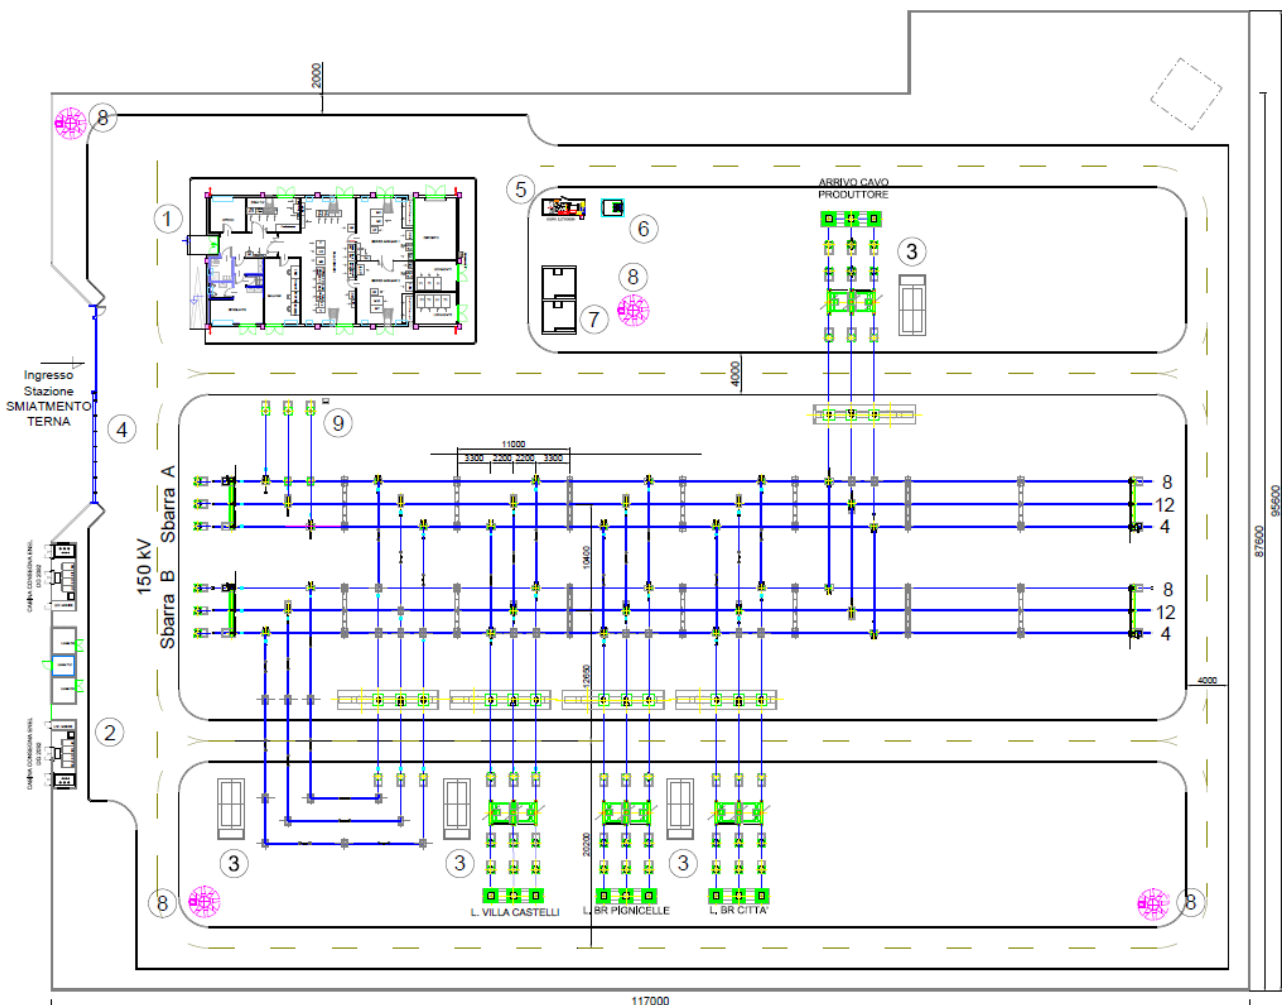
Layout definitivo della nuova stazione di smistamento da realizzare per la connessione dell'impianto alla RTN di TERNA
